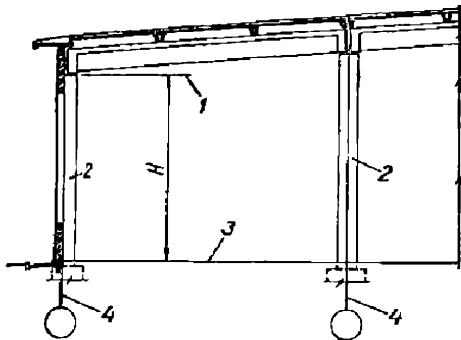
Высота крайних пролетов зданий без мостовых кранов при наружном отводе воды:
